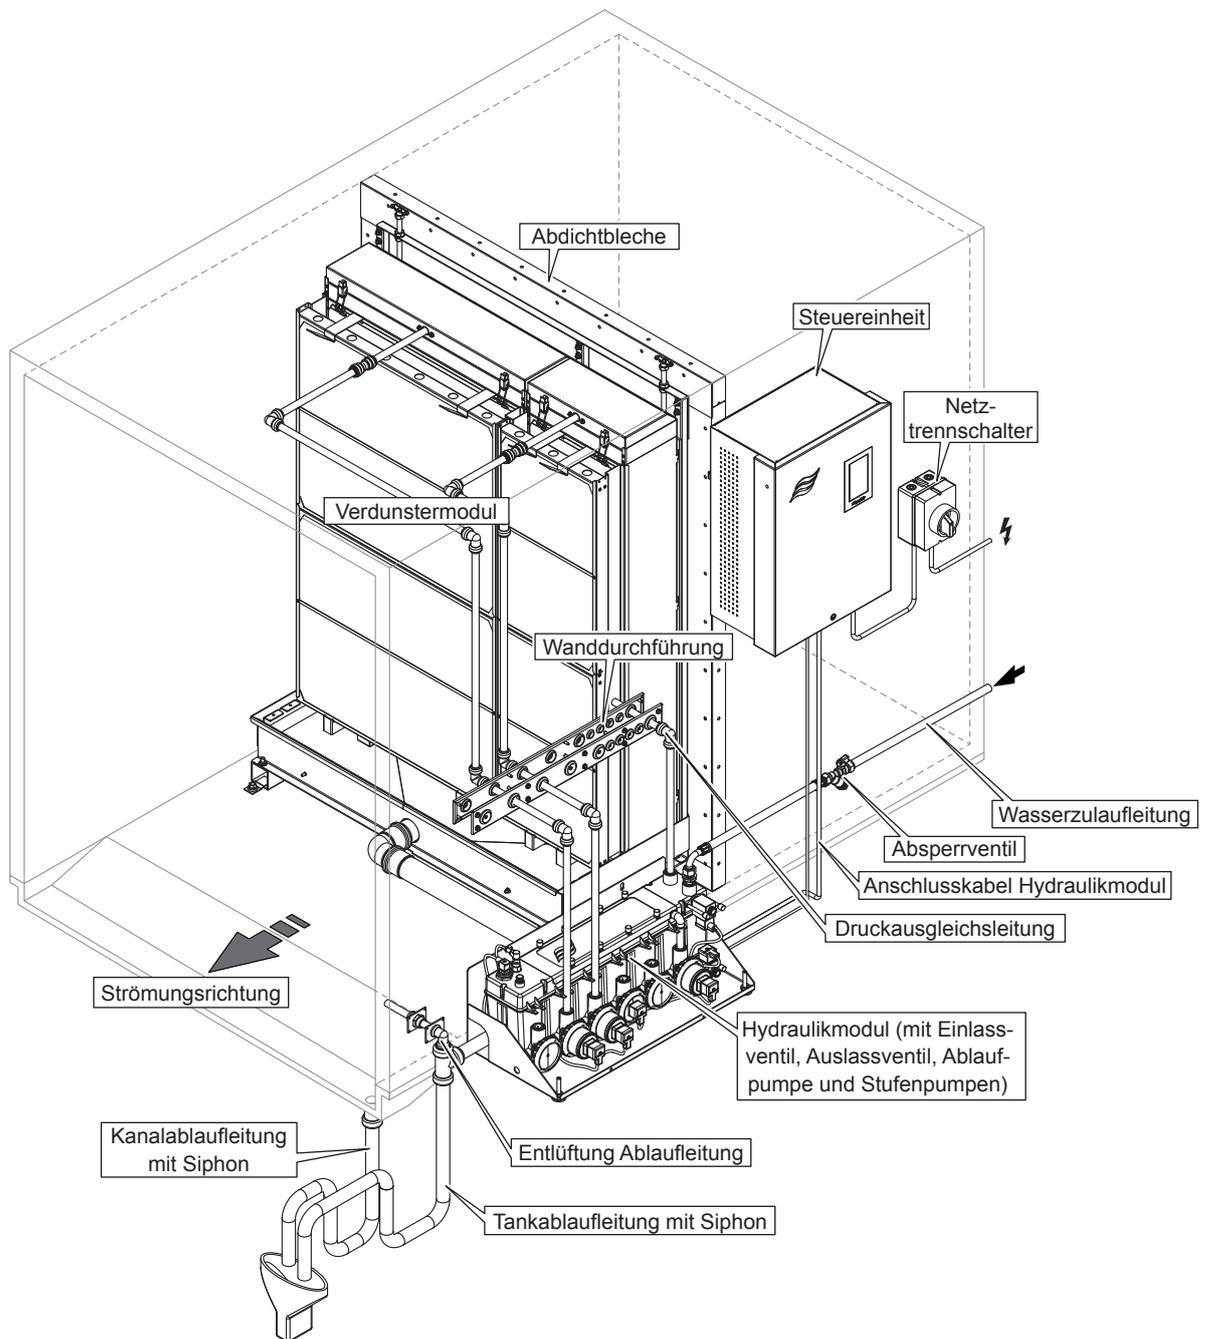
Typisches Condair ME Control System mit Wassertank mit Zentralablauf und einem Hydraulikmodul, Aussenmontage (Verdunstermodule bis 4.2 m/165" Breite)
